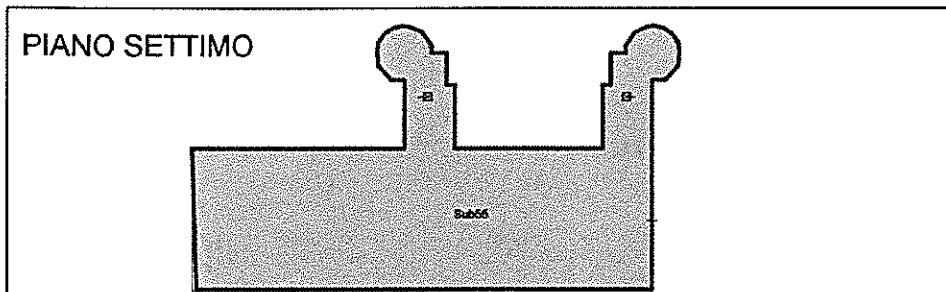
Elaborato planimetrico piano 7. Individuazione sub 56.
